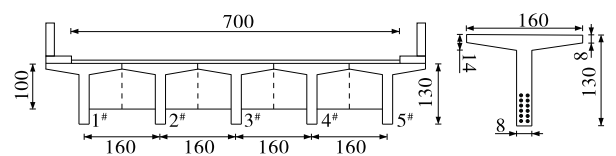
T 梁桥横截面尺寸及配筋示意图(单位:cm)
